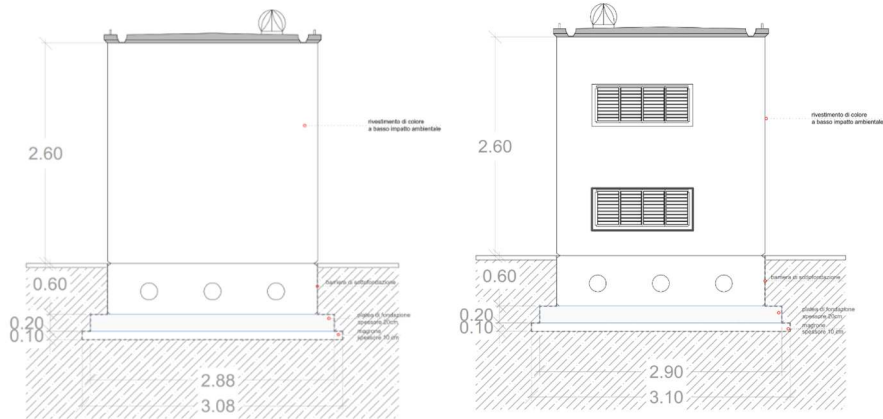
Prospetto frontale con platea di fondazione della cabina di Raccolta
